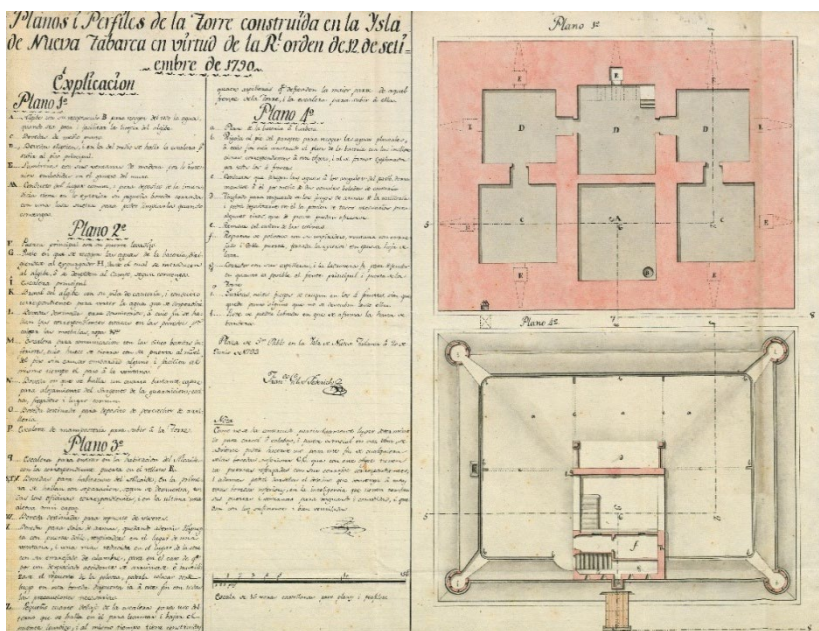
Planta izquierda de “Planos i Perfiles de la Torre construida en la Isla de Nueva Tabarca en virtud del R. orden de 12 de setiembre de 1790”, Francisco Gilver Federichi, Plaza de San Pablo en la isla de Nueva Tabarca a 20-junio-1793 (SHD-París).
